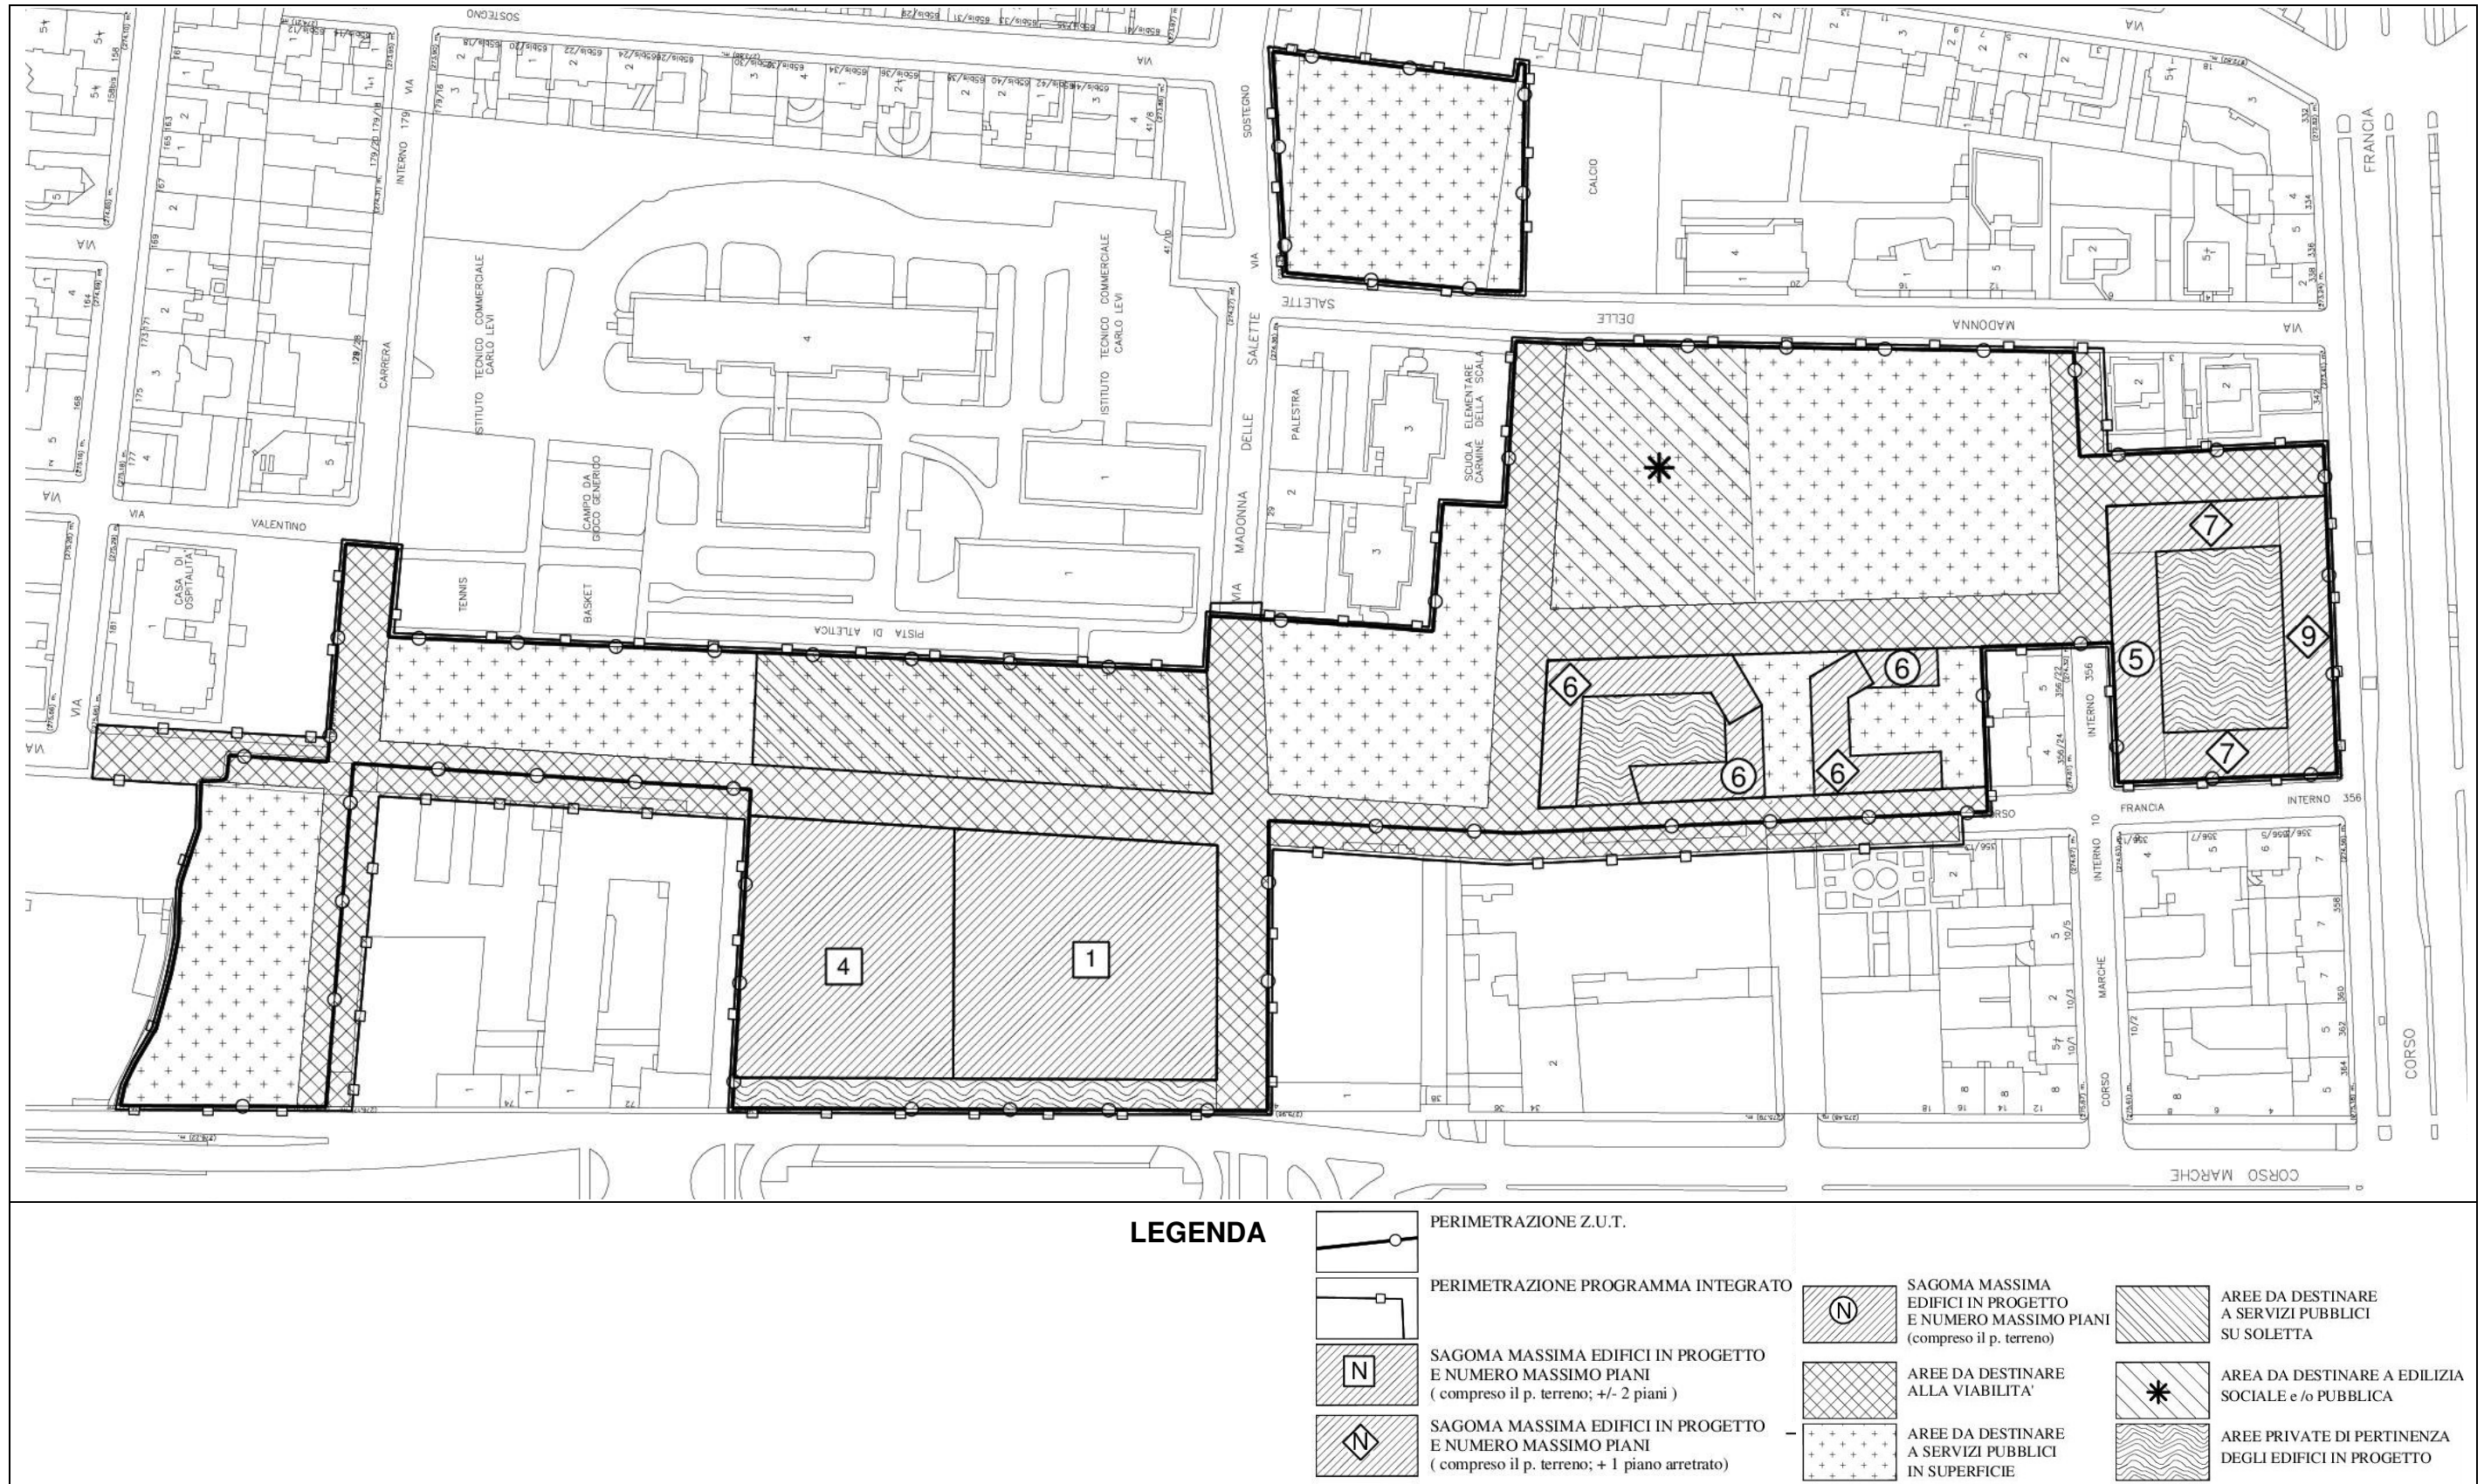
Planimetria di progetto della modifica al PRIN
